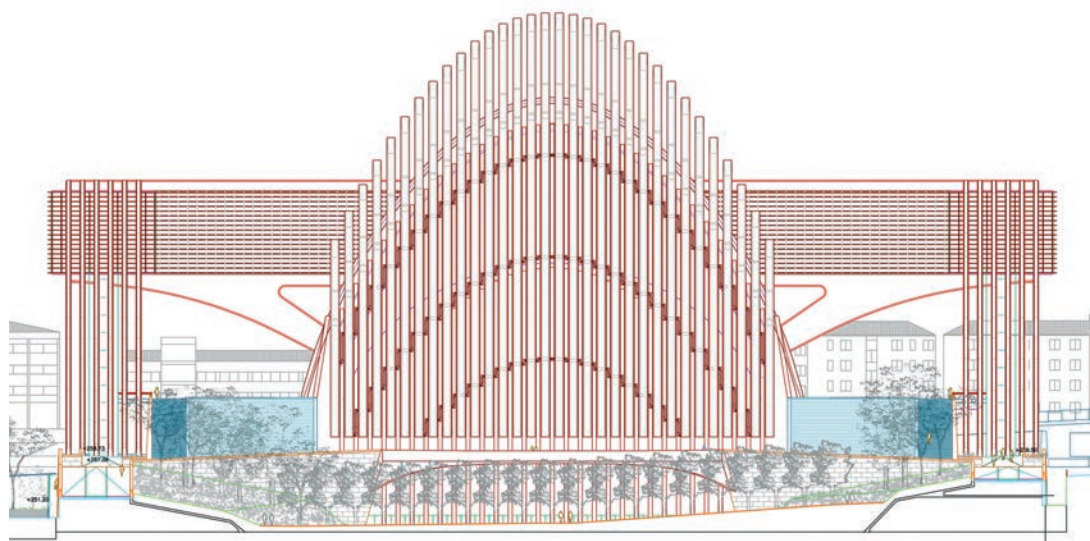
Alzado norte del conjunto de edificaciones Buenavista
